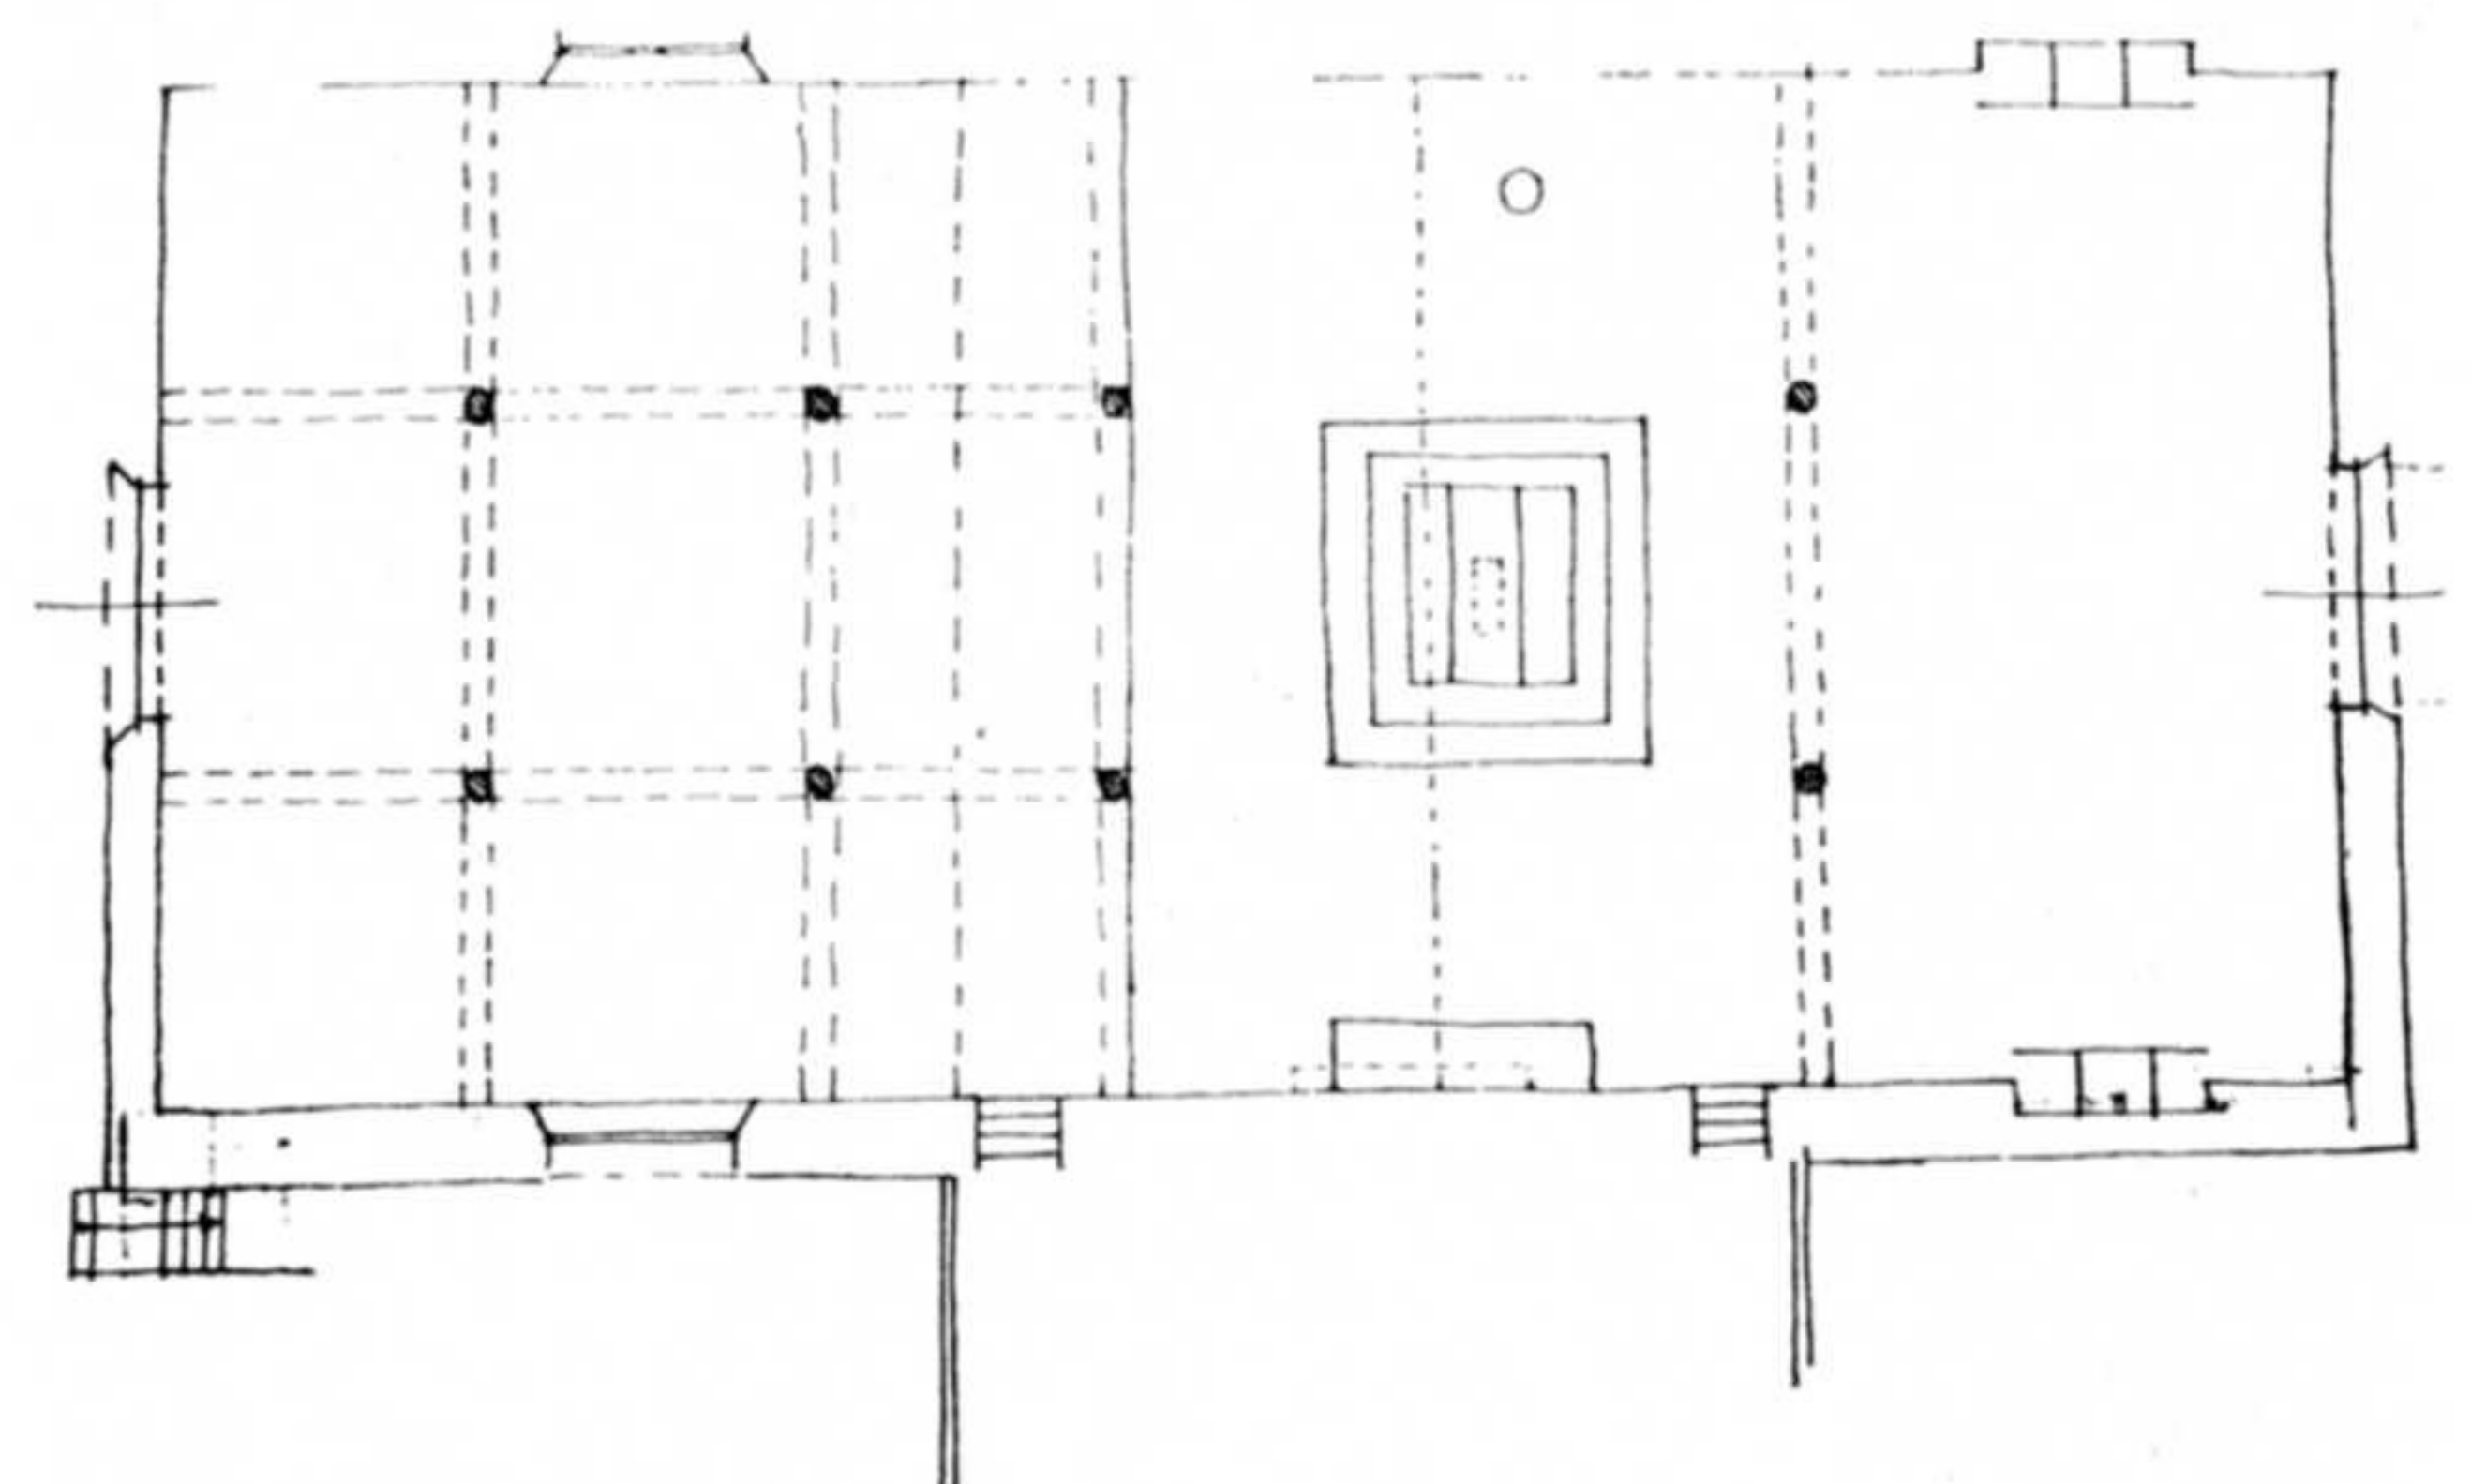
„Bau-Aufnahme“ durch Schätzen, Grundrißversuch, Pfarrkirche Parsch, Blei und Tusche, etwa 30/40 cm. Werkstattseminar 1974
